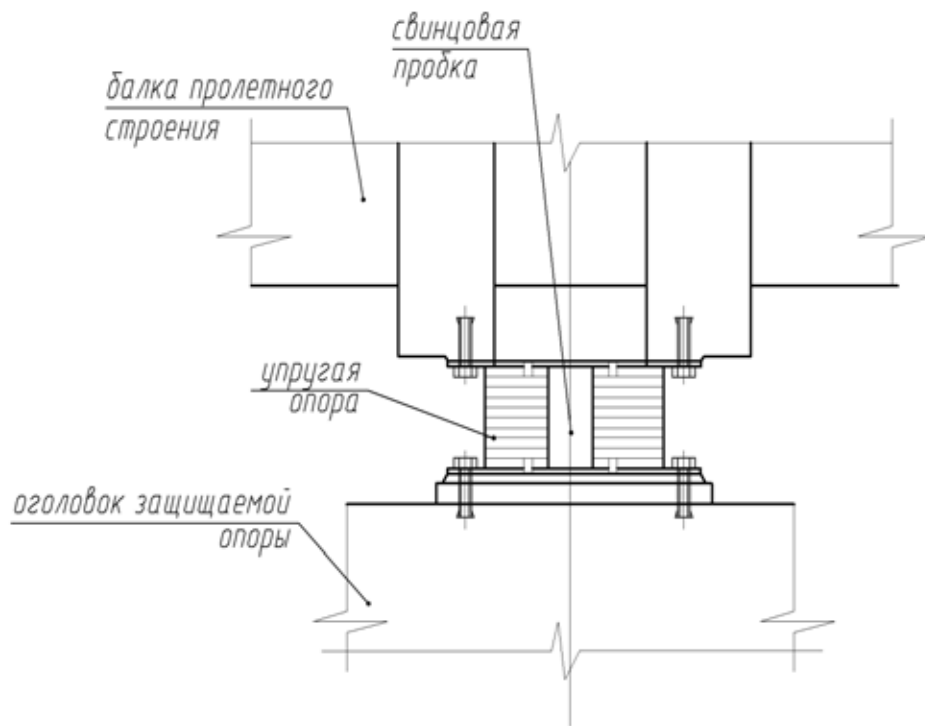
Общий вид резиновой опорной части (РОЧ)
